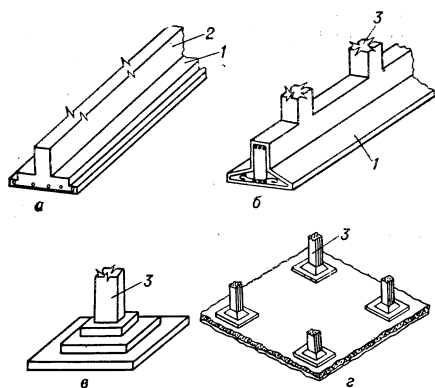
Монолитные фундаменты мелкого заложения: а — ленточный под стену; б — ленточный под колонны; е — отдельный под колонну; 1 — плитный под колонны; 2 — фундаментная стена; 3 — колонна.
